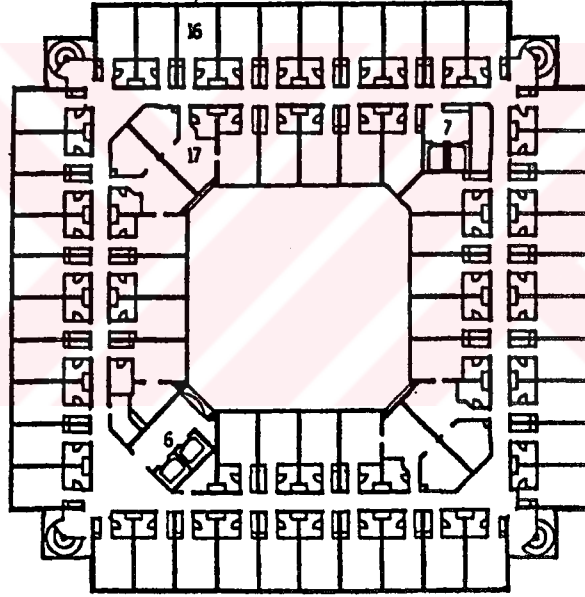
Hotel Kempinski, vaziyet ve 1. kat planı
